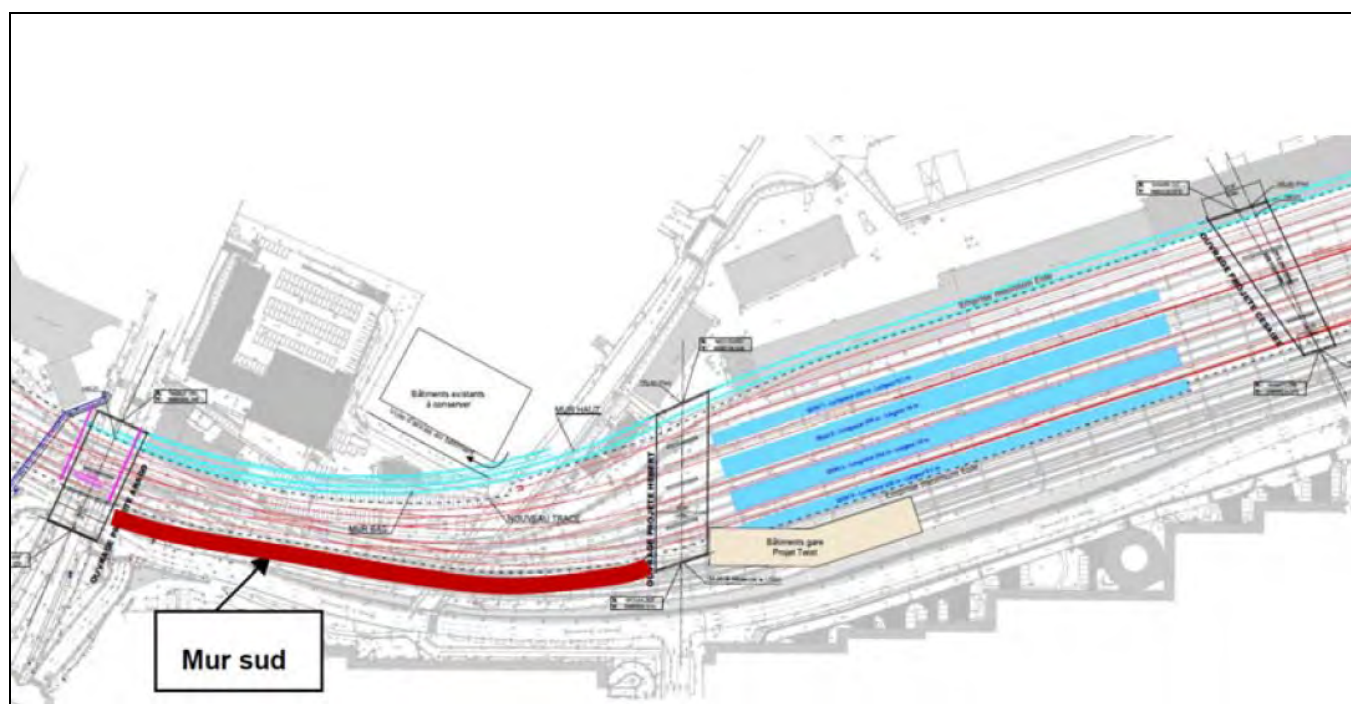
Plan de situation du mur de soutènement situé au sud de la RD 914
